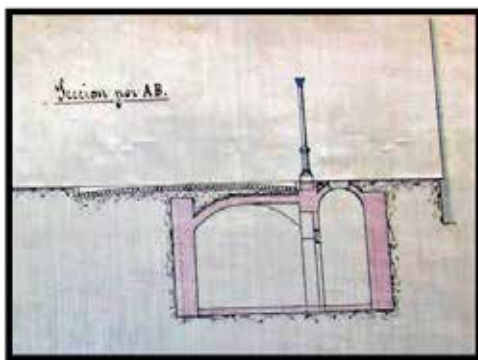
Detalle de las obras subterráneas. Fuente: Legajo 558. AHMM.
